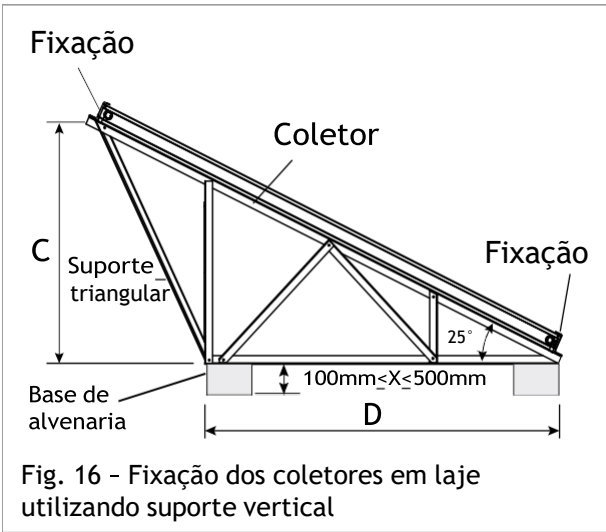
Fixação dos coletores em laje utilizando suporte vertical
